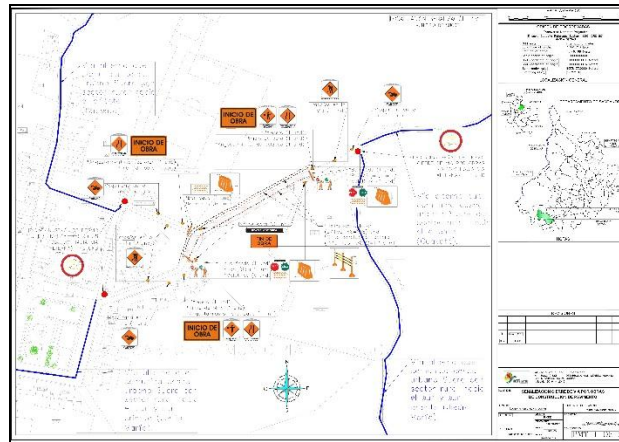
PMT para la construcción del pavimento en Sucre, Santander.
